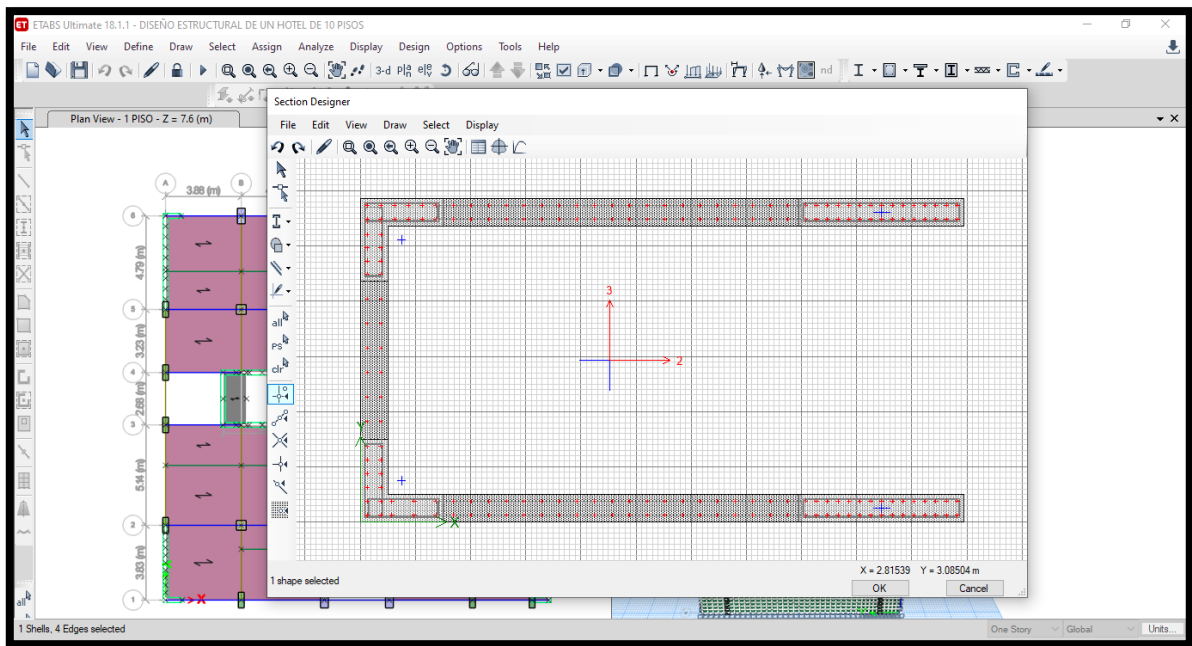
Vista en planta del armado de acero en la sección de la escalera: PL – 03.
